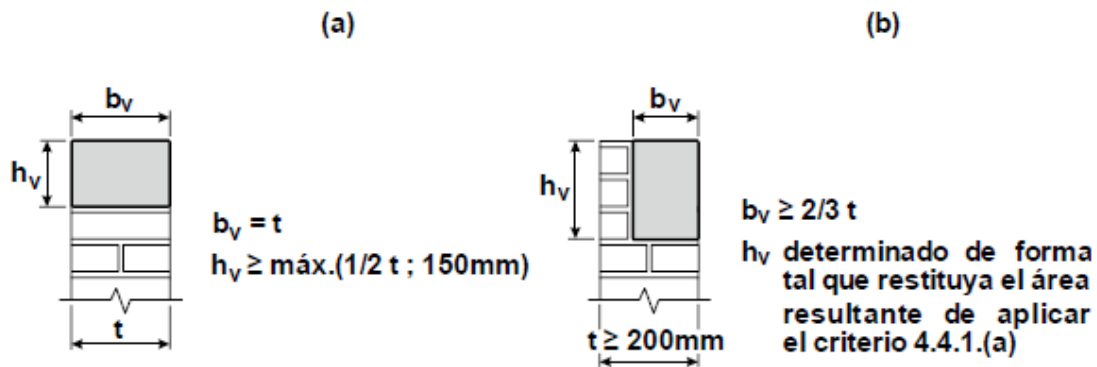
Sección transversal de vigas de encadenado de hormigón armado.
